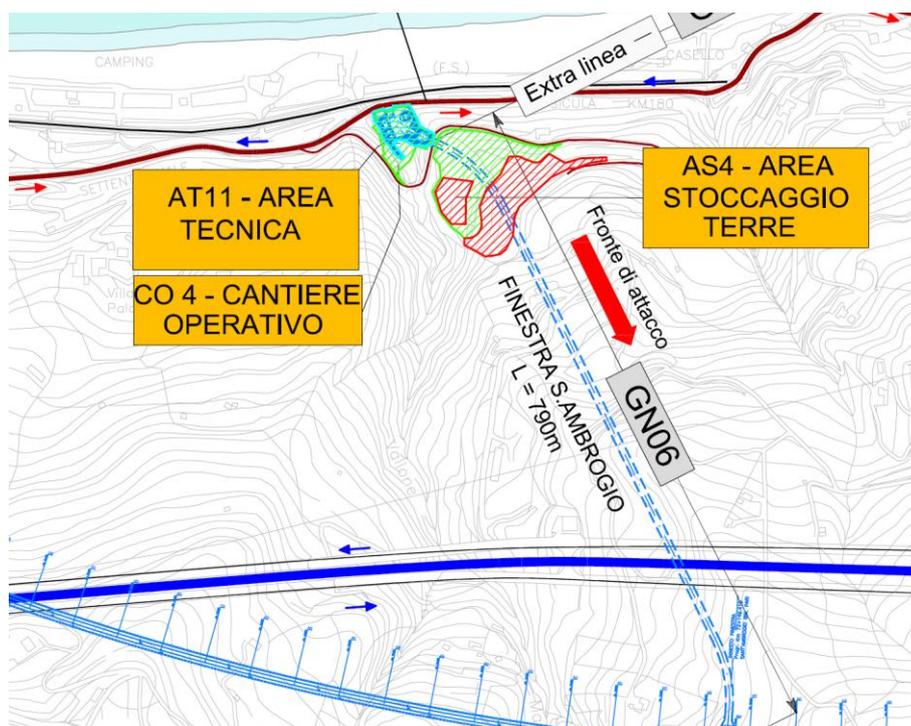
Stralcio planimetrico della Zona Finestra S. Ambrogio, con indicazione delle aree di cantierizzazione AS4 e CO4.
